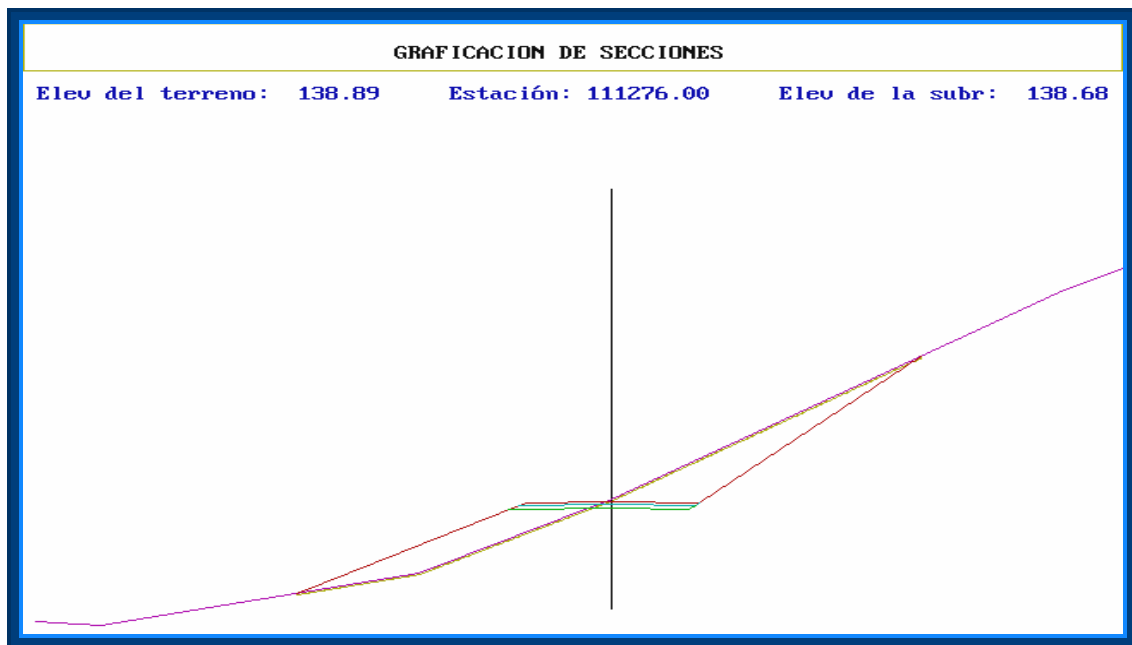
SECCIÓN EN BALCÓN.
